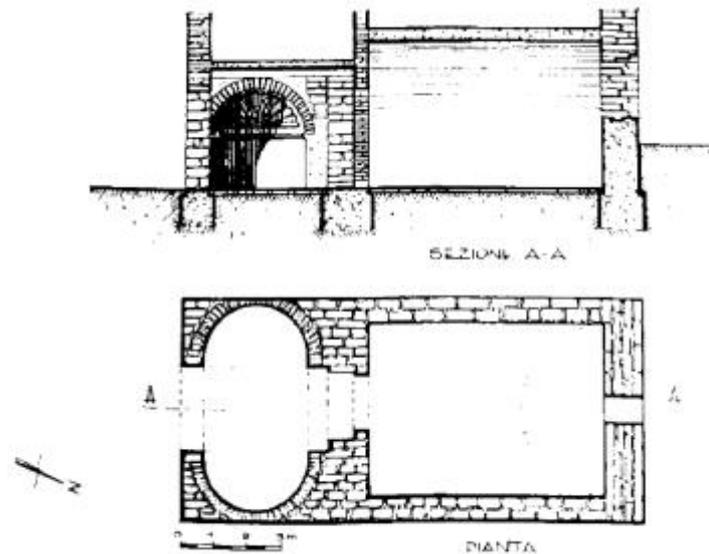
Castrovillari, Familongo. Sezione e pianta del mitreo (da TROMBETTI, RUSSO 1987)
